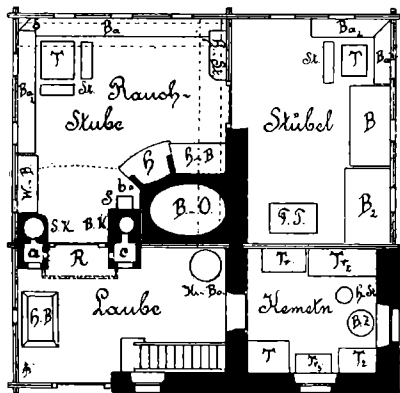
Grundriss des Erdgeschosses des Gasperle-Hauses.
